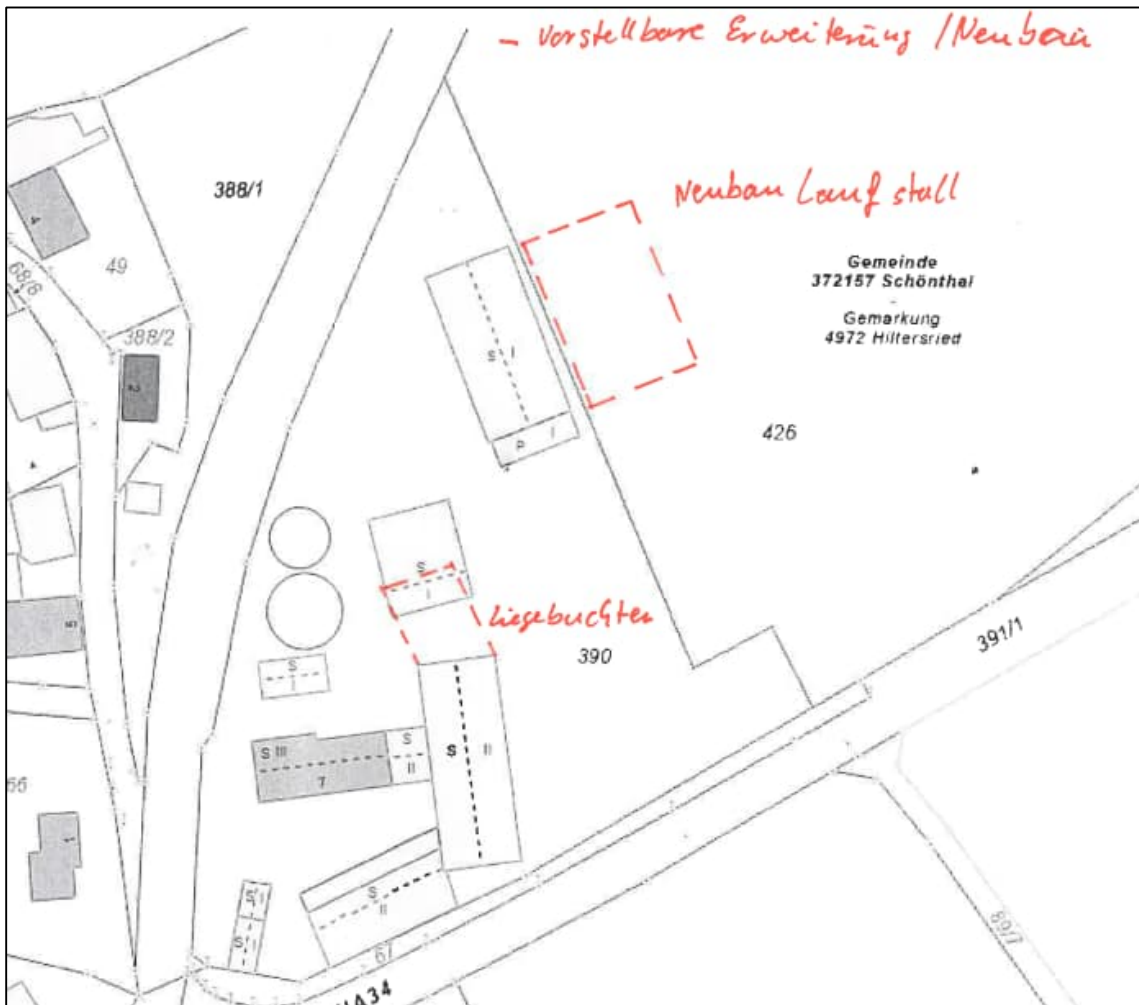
Lageplan mit Kennzeichnung der Erweiterungsabsichten des Landwirts
